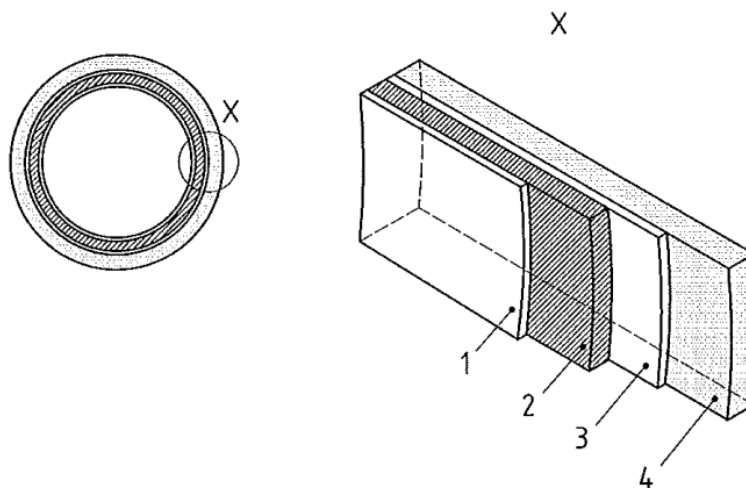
TIPICA COSTRUZIONE DELLA PARETE DEL LINER
